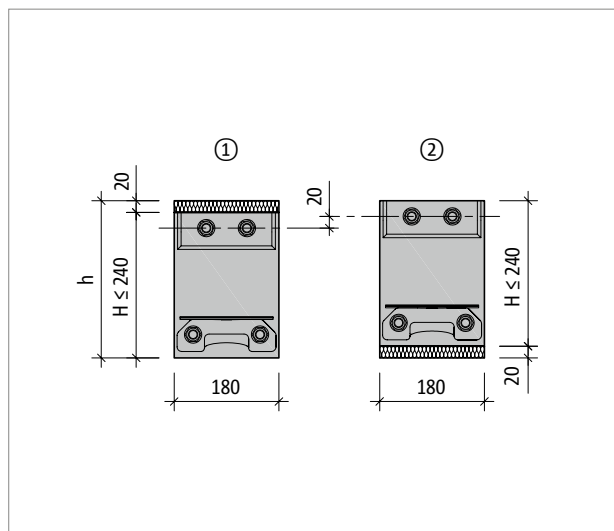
Schöck Isokorb® T type SK : Disposition avec décalage de hauteur
